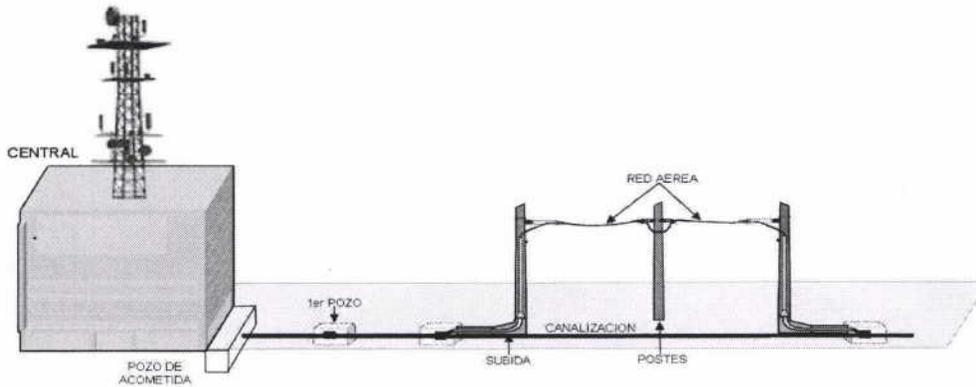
Edificio, Torre, y Obra Civil de Telnor.
